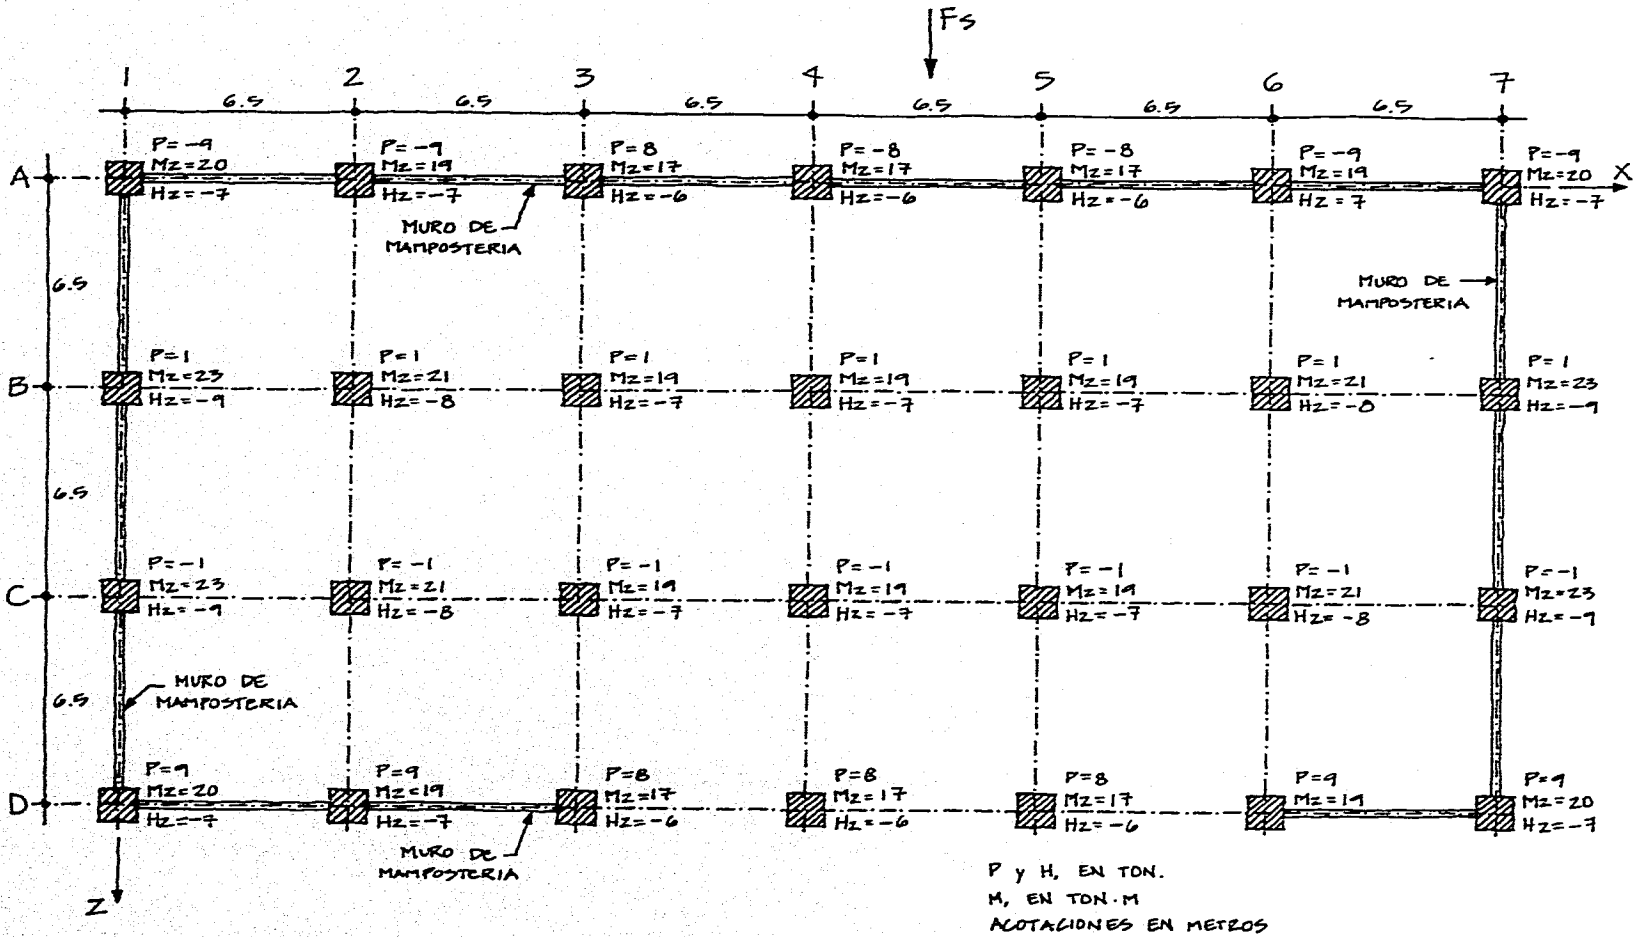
PLANTA DE CARGAS POR COLUMNAS AL NIVEL DE CIMENTACION
